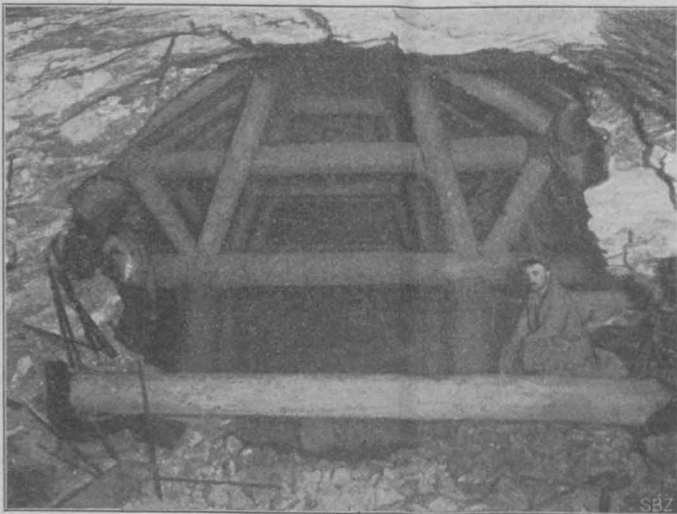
Tunnel I, Km 8.9, Vollaushbruch
